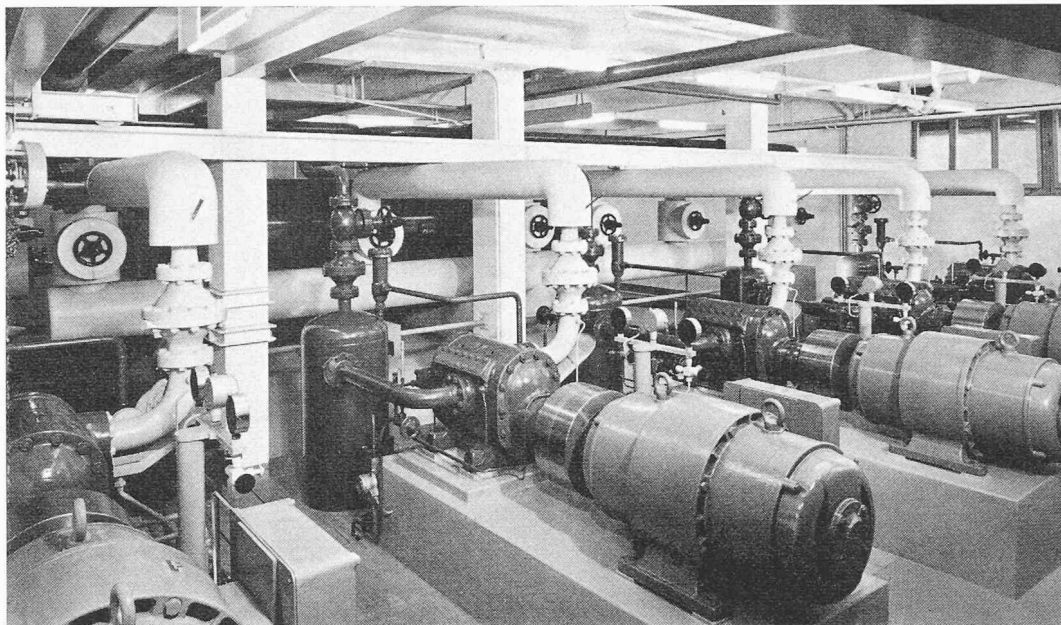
Maschinenraum mit fünf Rotasco-Kompressoren
